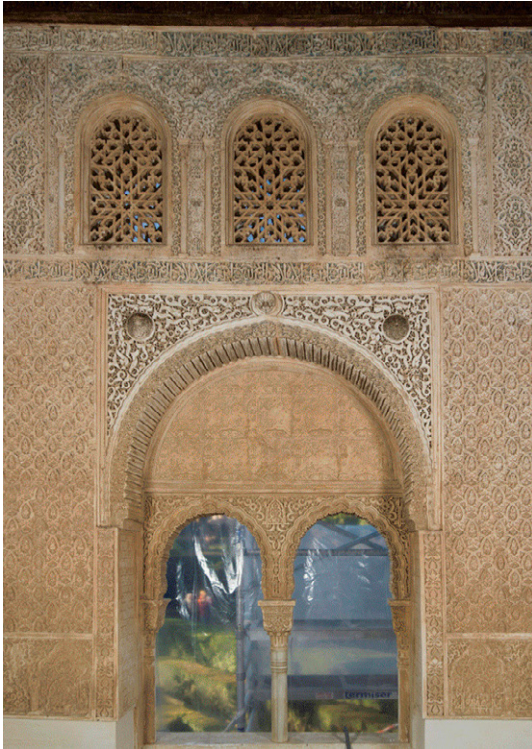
Estado inicial de las yeserías de la fachada interior lateral suroeste.
